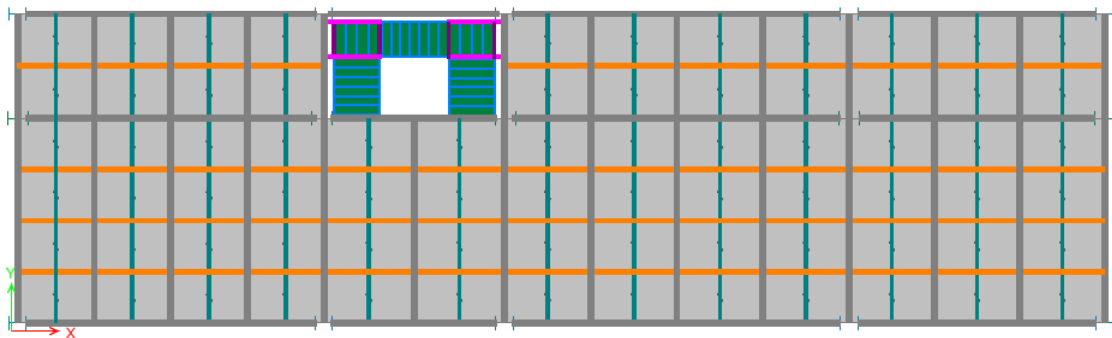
Análisis de la superestructura del Sistema Estructural Mixto – Vista en planta.
